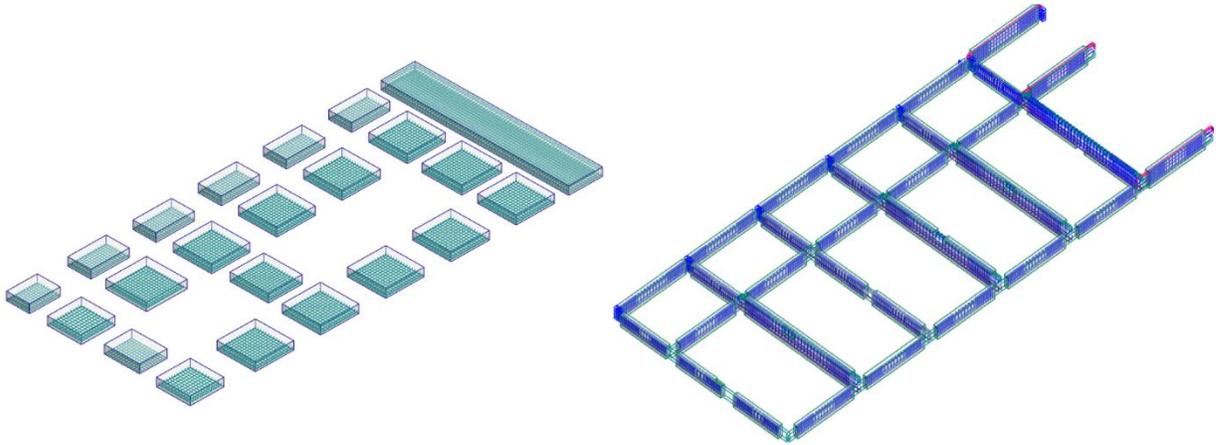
Modelado Estructural de Zapatas y Vigas de Cimentación (REVIT)
